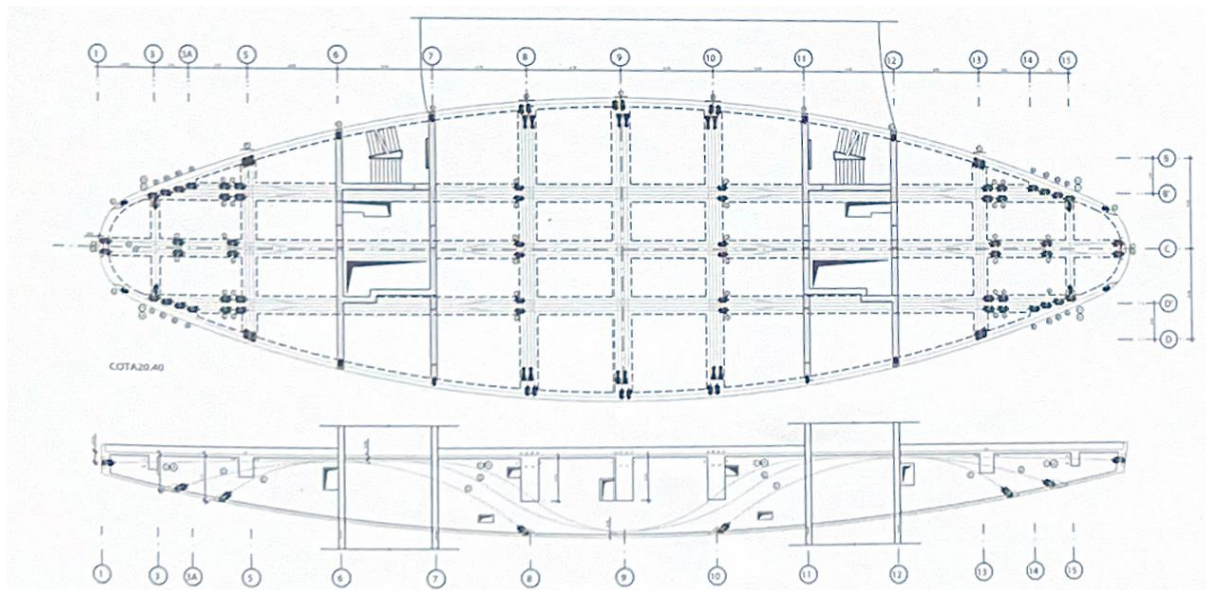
Planta e corte da laje de transição, (Appleton et al., 2000)
